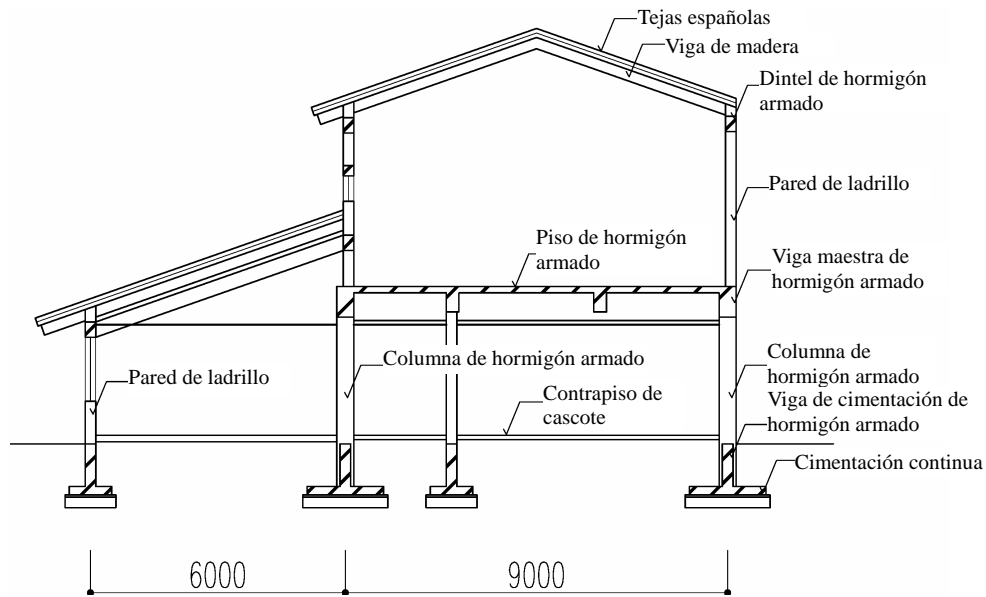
9 Según tipo de estructuras (Sección de dos plantas)
